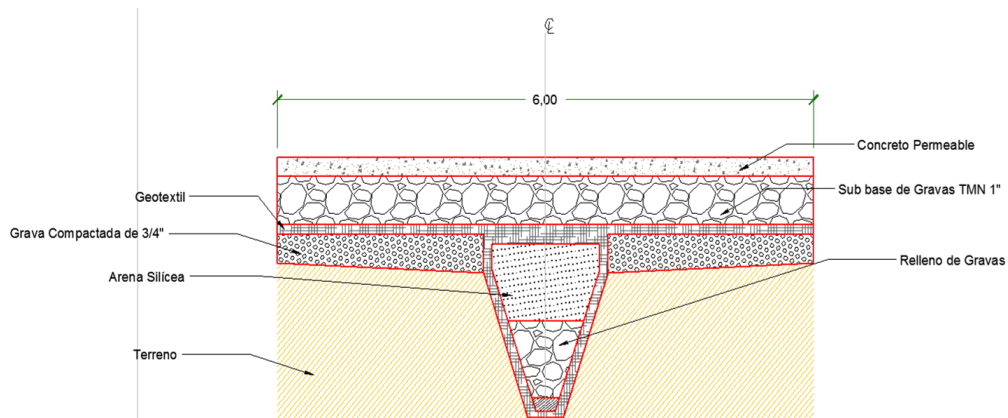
Pavimento Permeable con Dren Francés Subterráneo
